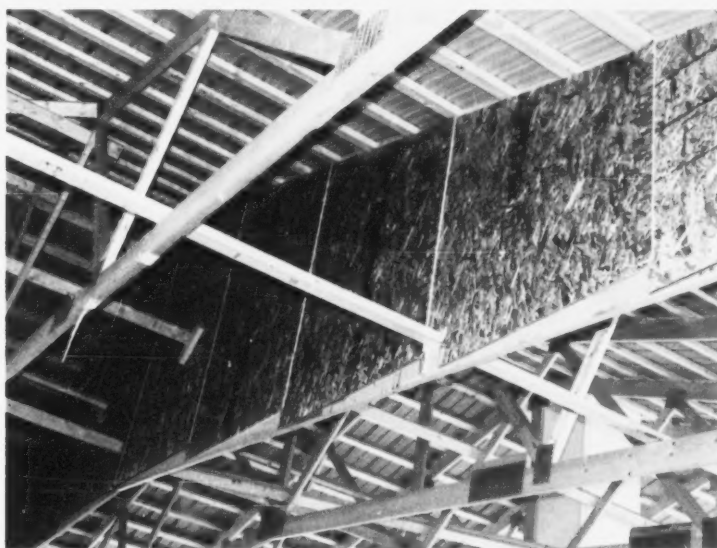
Exemple de coupe-feu dans le vide sous-toit d'une étable à veaux en construction.
